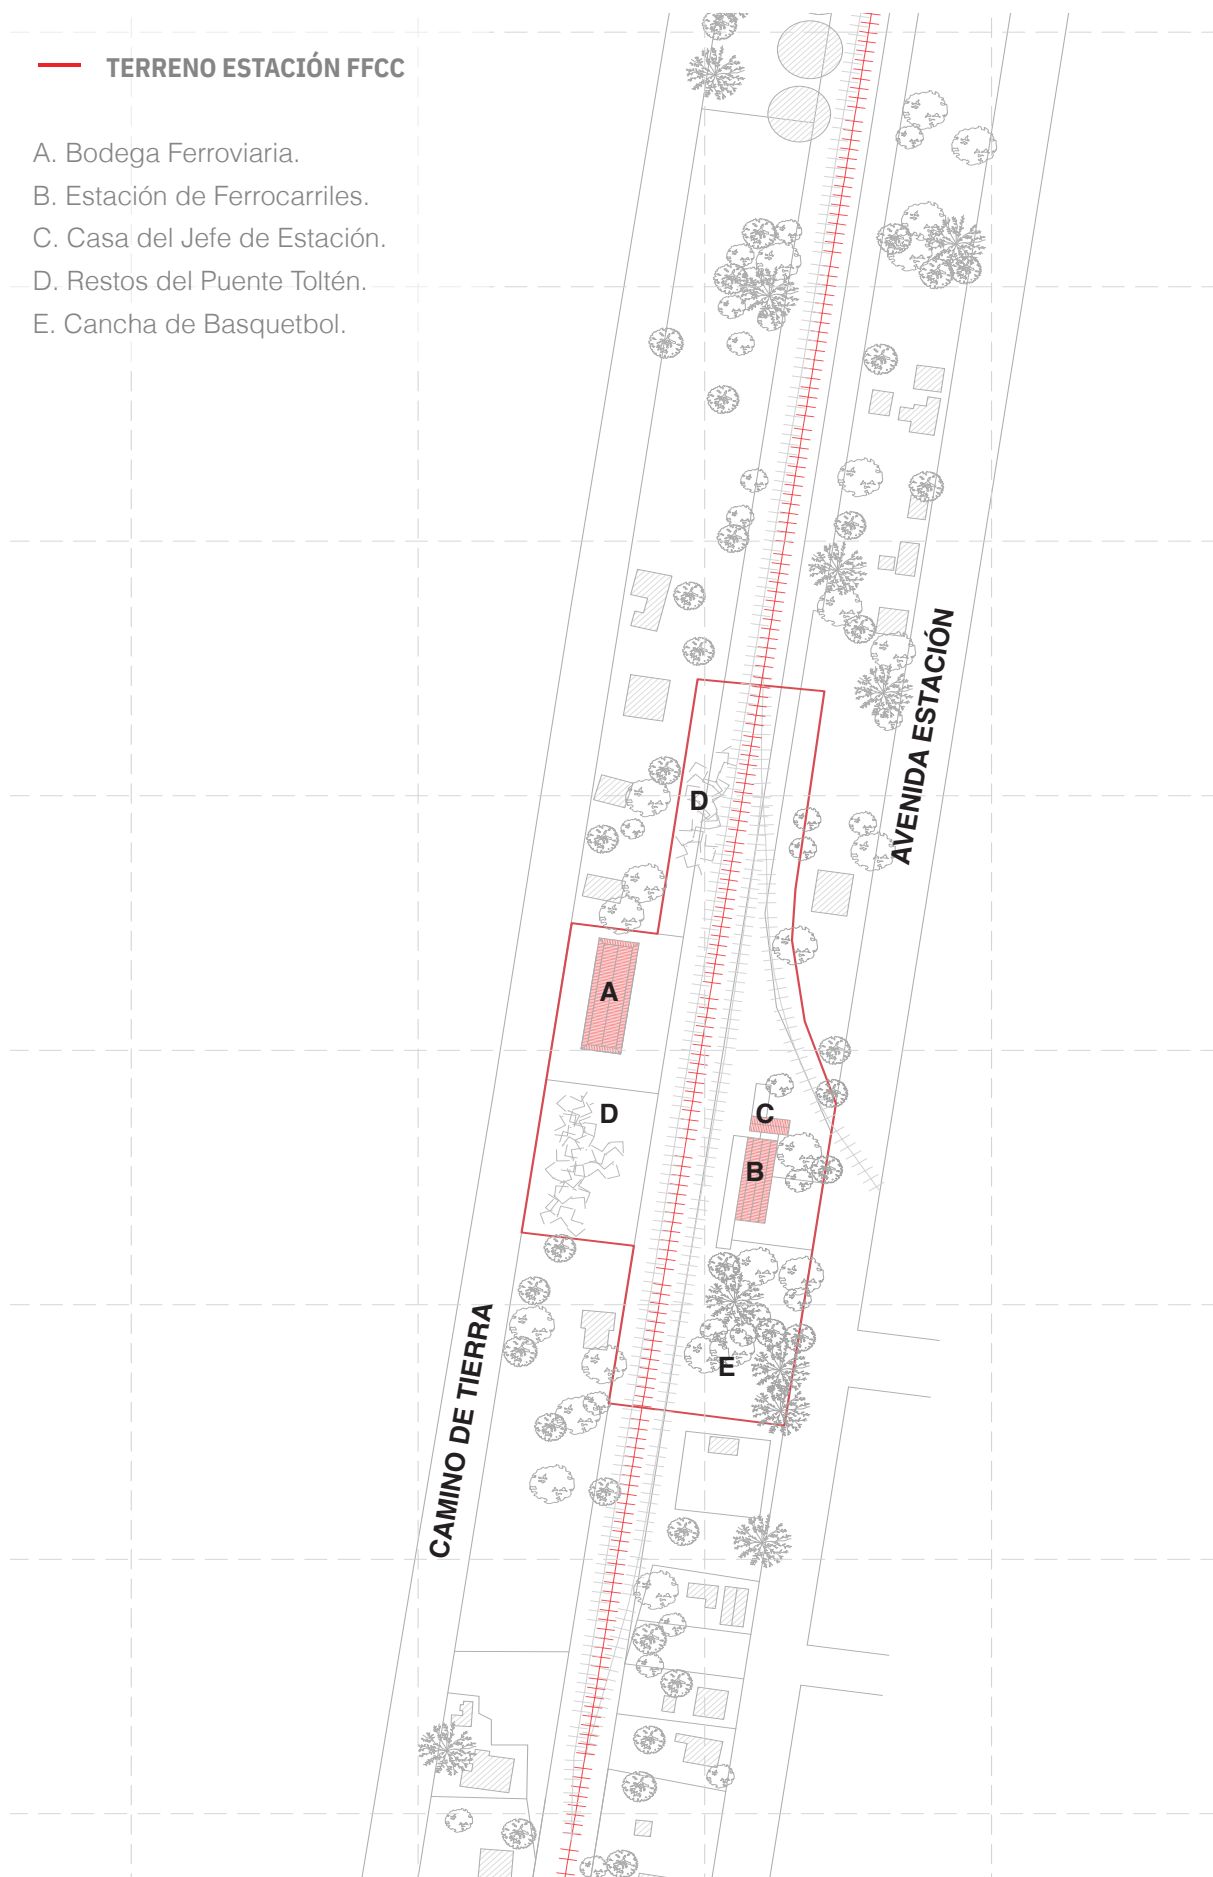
Terreno de Estación. Elaboración Propia a partir de planimetría de EFE.
